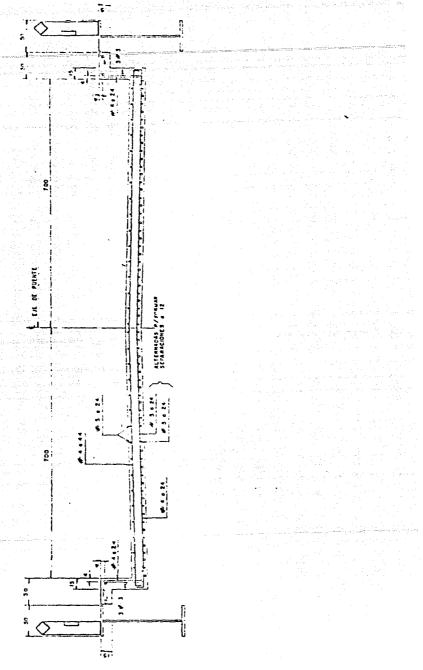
SECCION TRANSVERSAL DE LA LOSA DE PUENTE.
